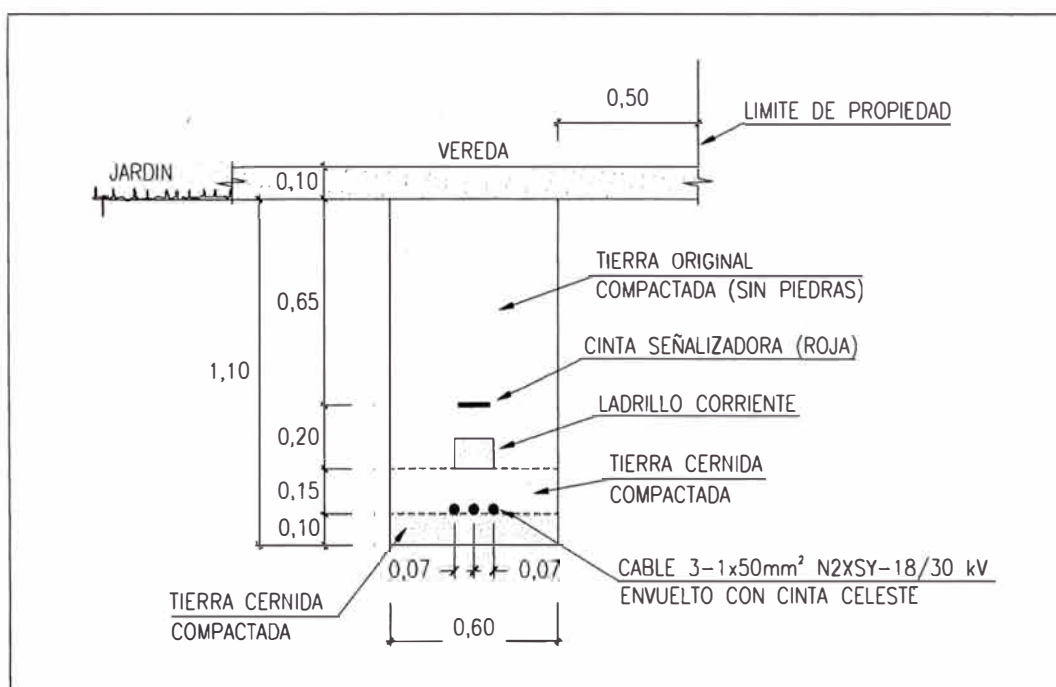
Detalle de instalación de cable bajo vereda (corte A-A).
